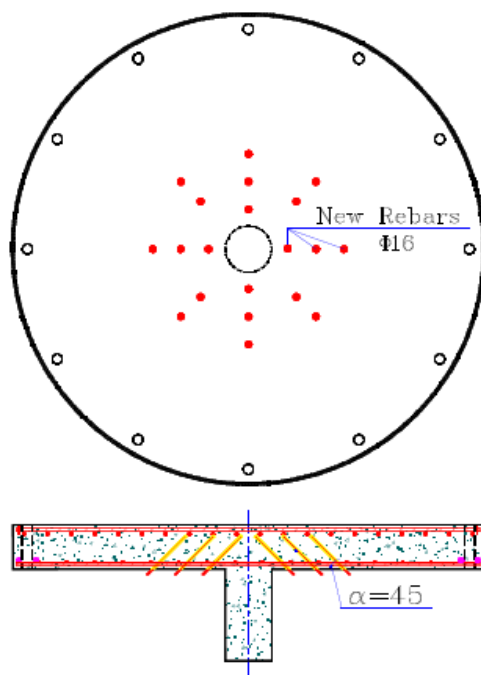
Laje reforçada com varões de aço transversais ensaiada por Hassanzageh [139][197].
